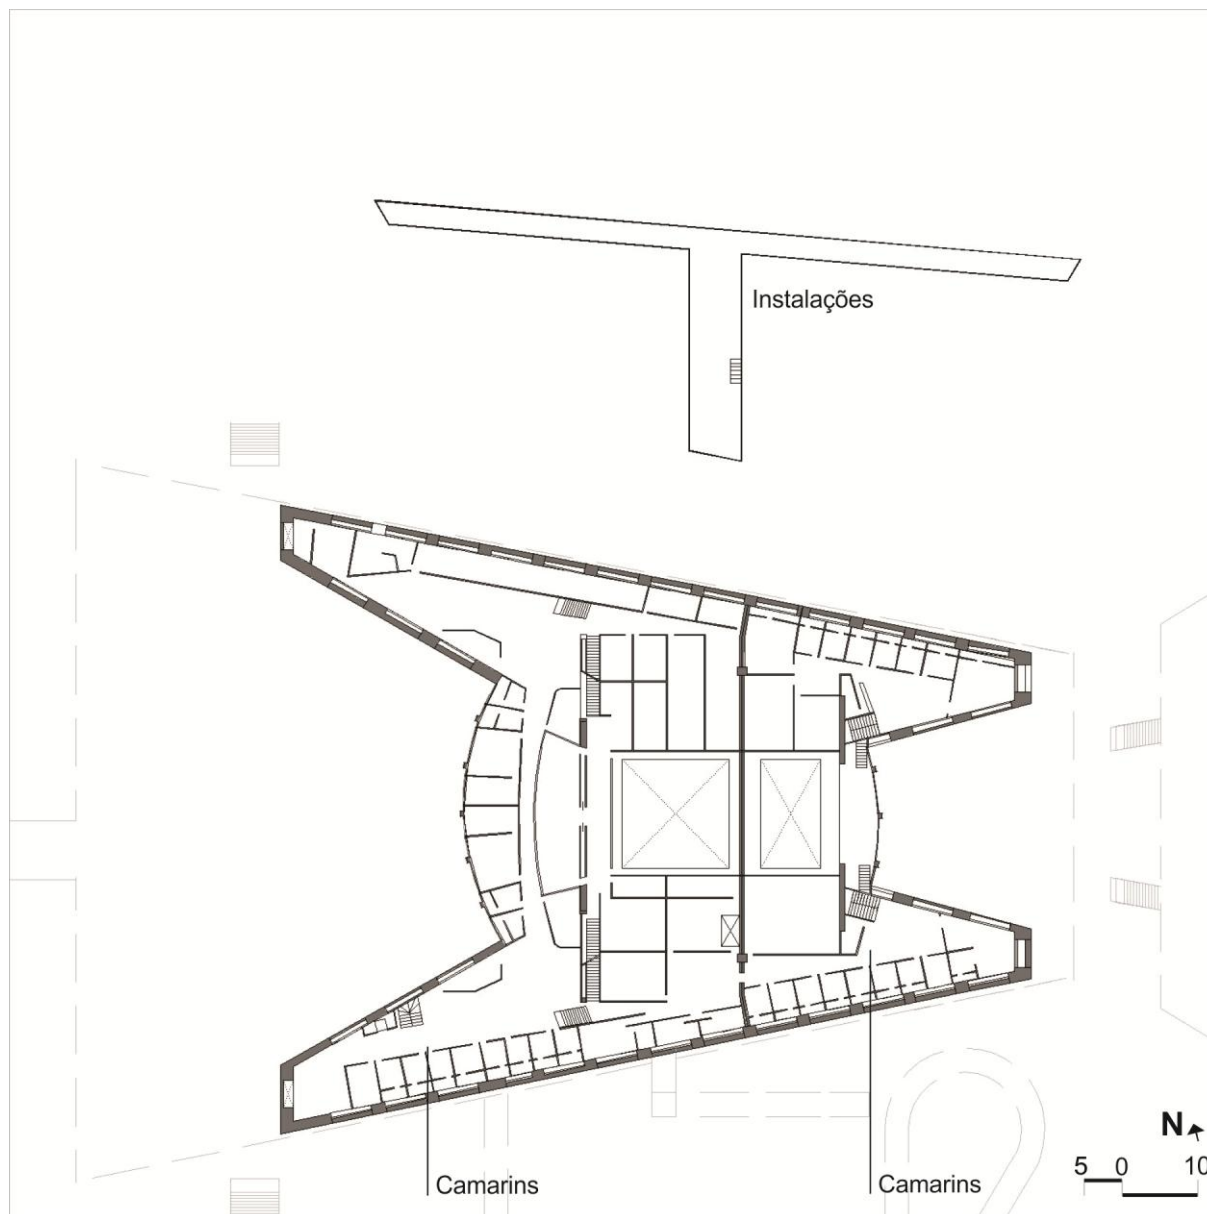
Planta Baixa - Subsolo 4 (-13,80 m).
